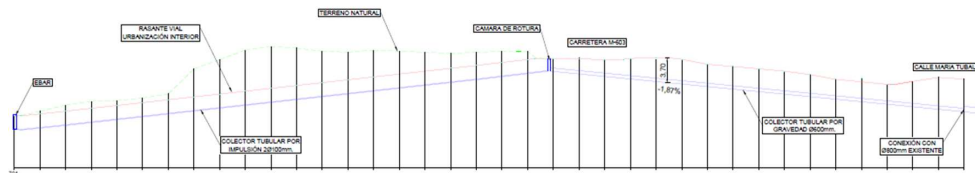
Esquema del perfil longitudinal de la conexión con la red municipal. Alternativa con EBAR. Solución elegida
